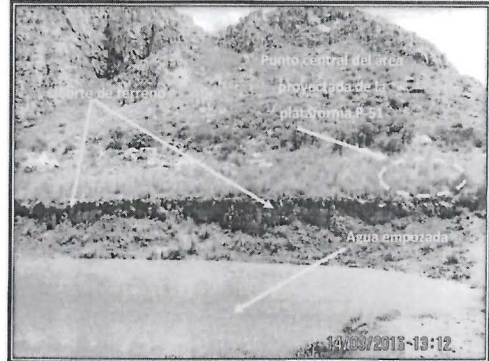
HALLAZGO 02: Vista del sondaje AC-38. Coordenadas de ubicación (Datum WGS 84 – Zona 19): E 186654, N 8453794.
